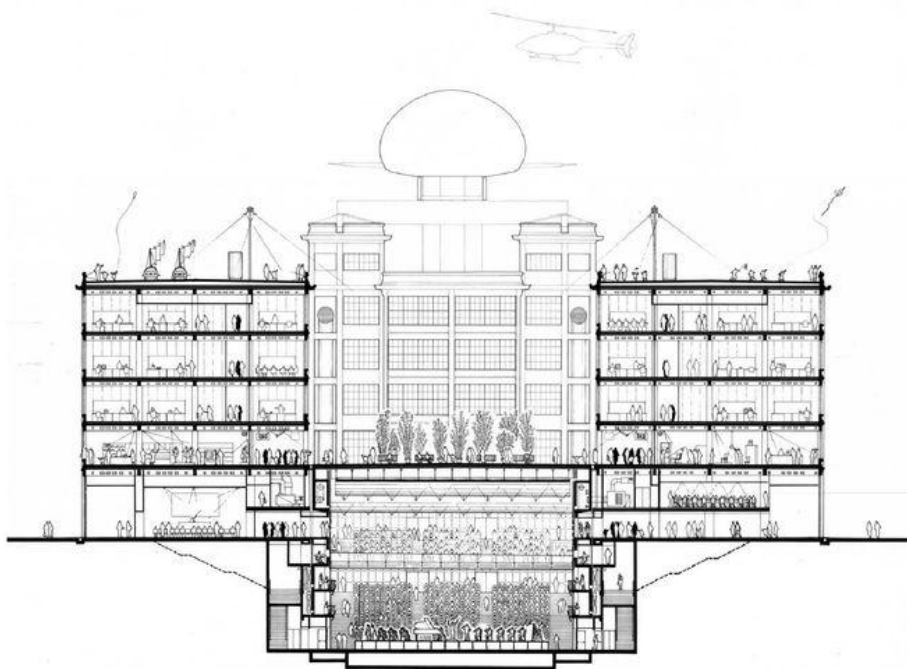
Renzo Piano Building Workshop: Propuesta de intervención en Lingotto, sección transversal E-W (1985) (Archivo RPBW)
